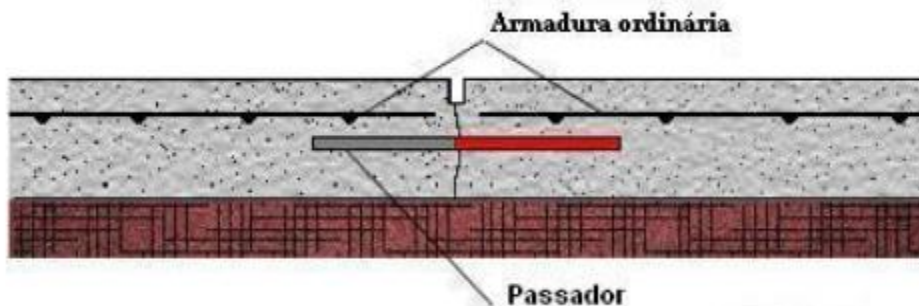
Perfil de pavimento em betão com juntas (Oliveira, 2000)
